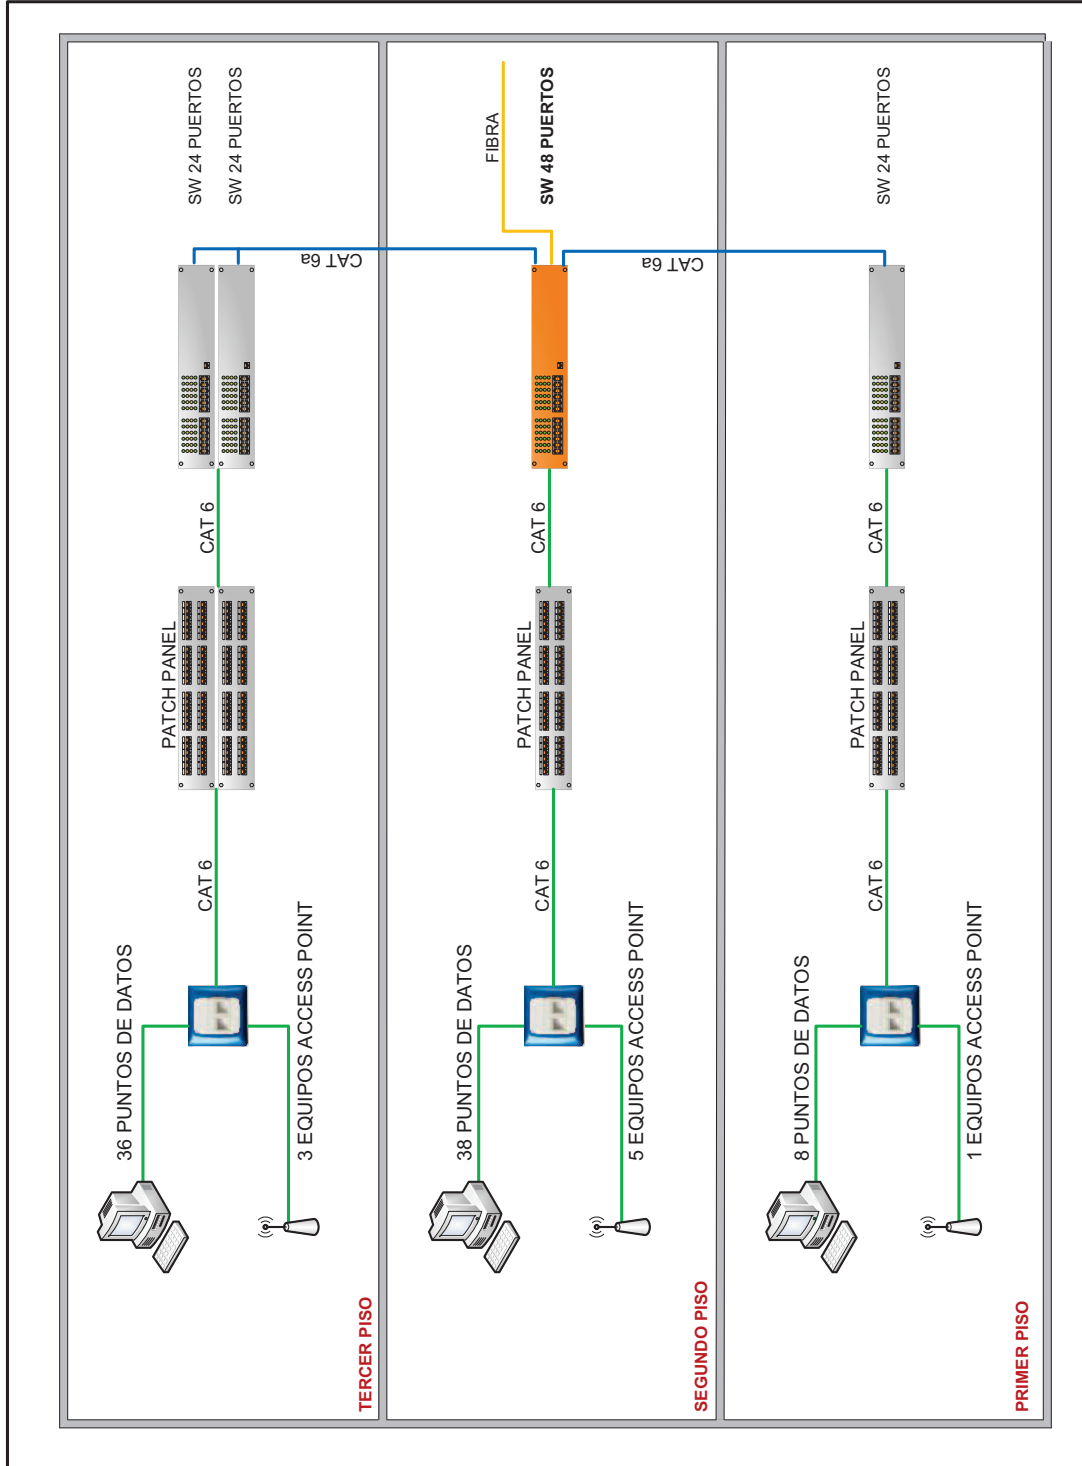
Cableado horizontal y vertical en el edificio Sur - Aulas
